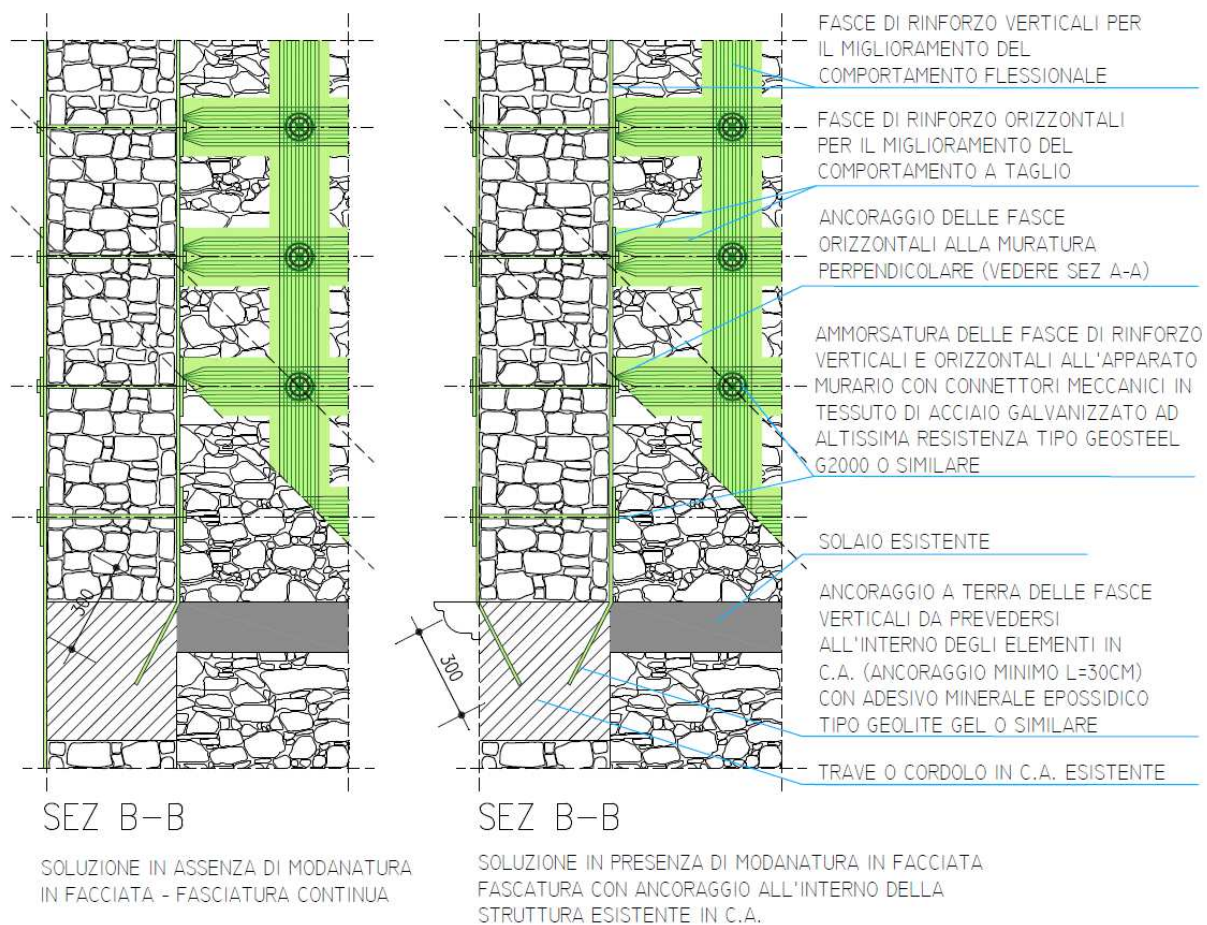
pianta rinforzo a taglio e flessione con tessuti in fibra di acciaio su muratura, sez. d'angolo e interna
